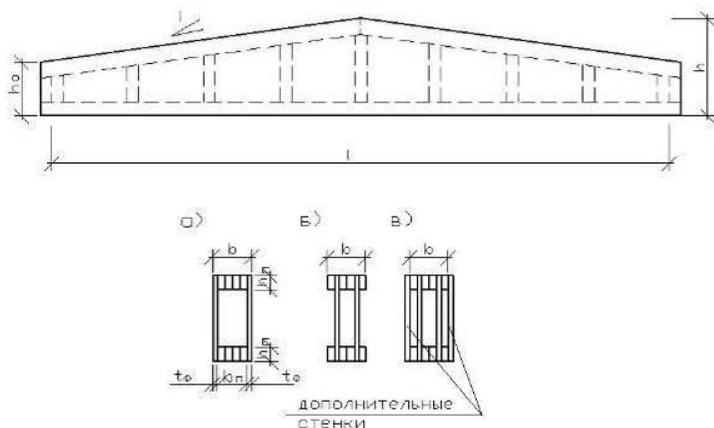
Общий вид клефанерной балки с поперечным сечением:
